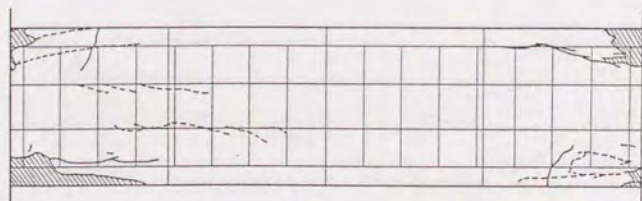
ひび割れ状況（試験体 B2）
